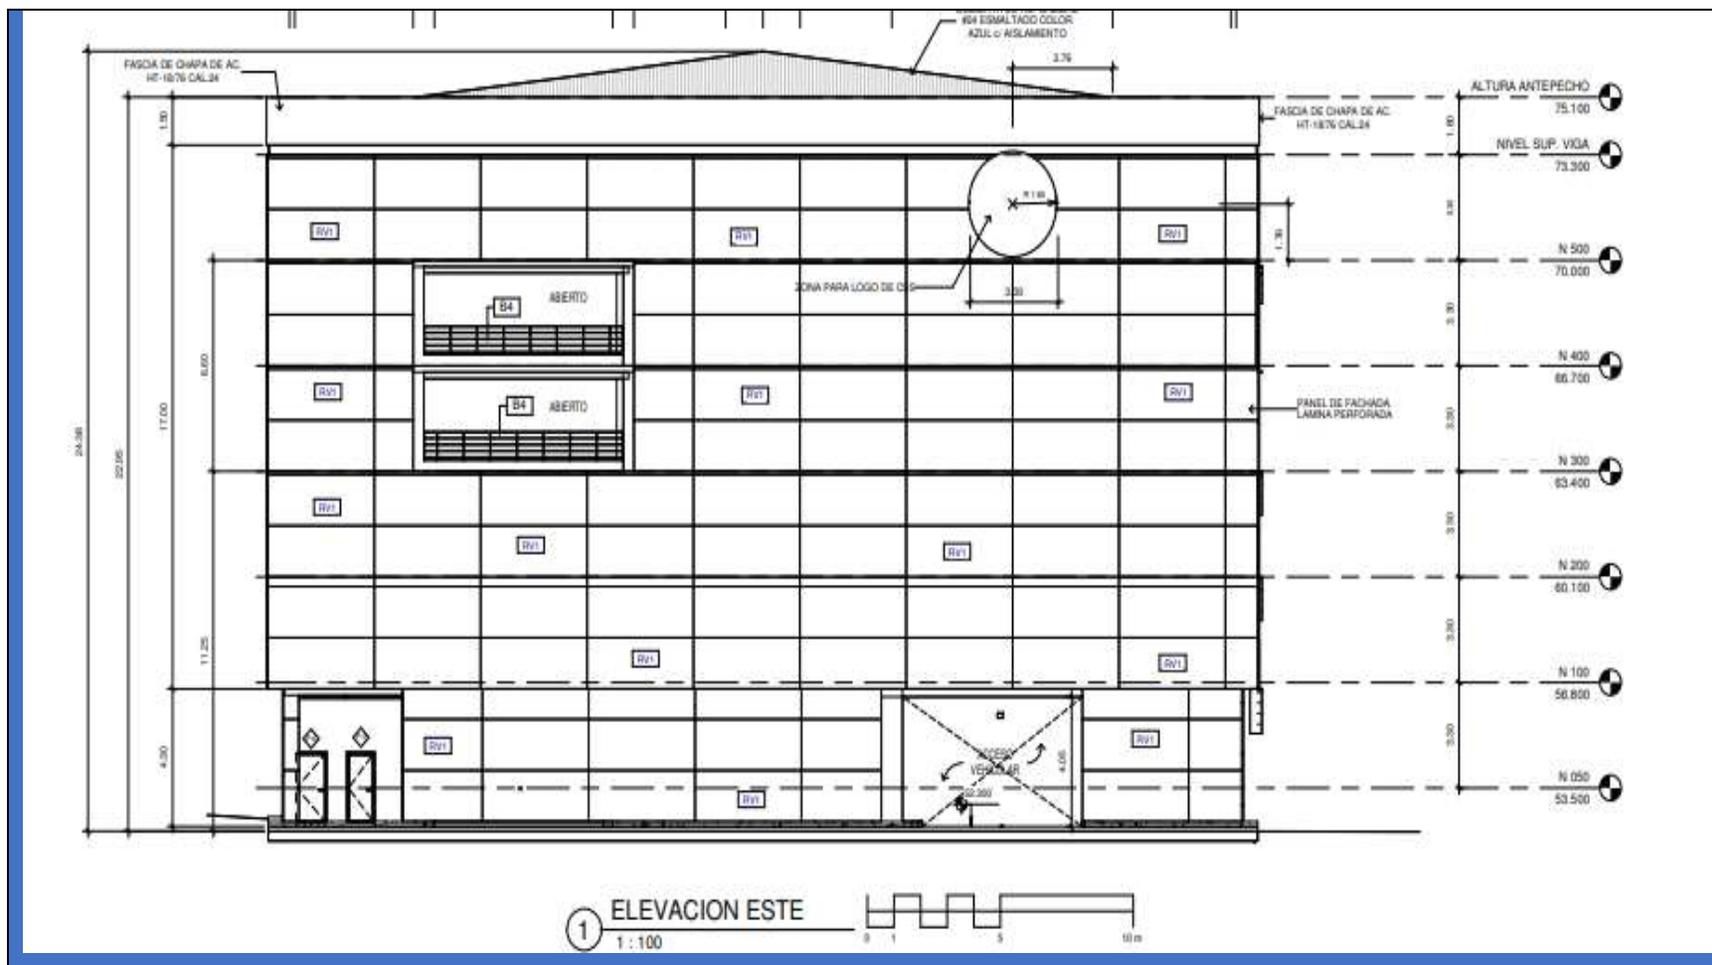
Perfil de Elevación Este del edificio de estacionamientos. Fuente: planos de proyecto
